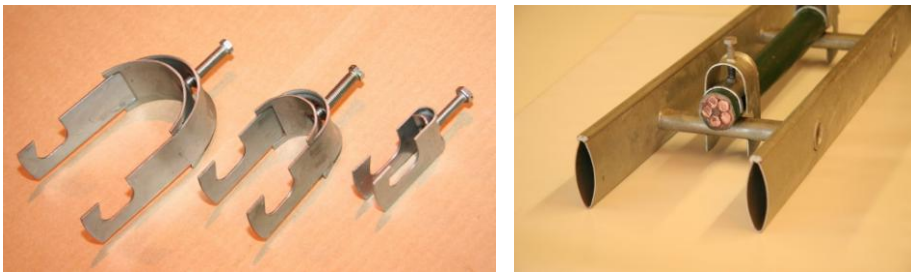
R-bøjler leveres i dimensioner 12-75mm. Til højre ses 30mm kabel monteret på Kabelstige KS-150) med R-bøjle.
